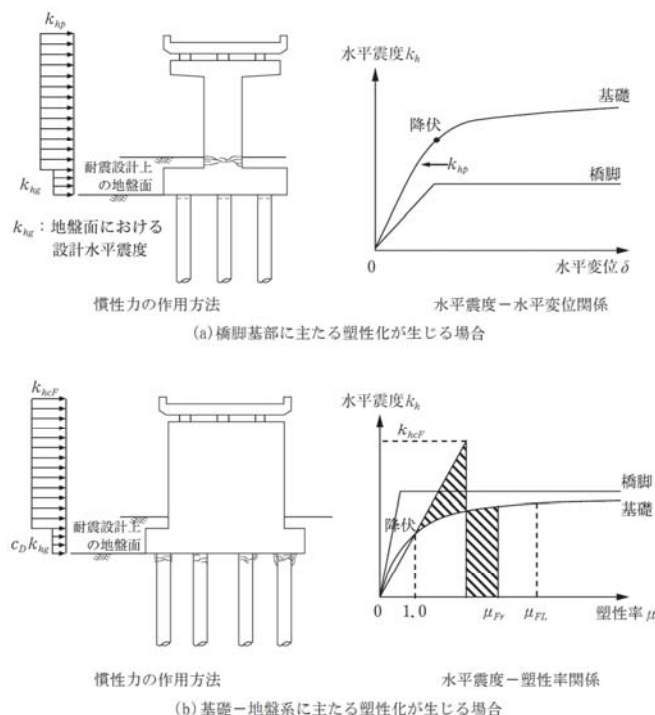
橋脚基礎の設計の概念図 (道示V編, 図-解 10.2.1)
